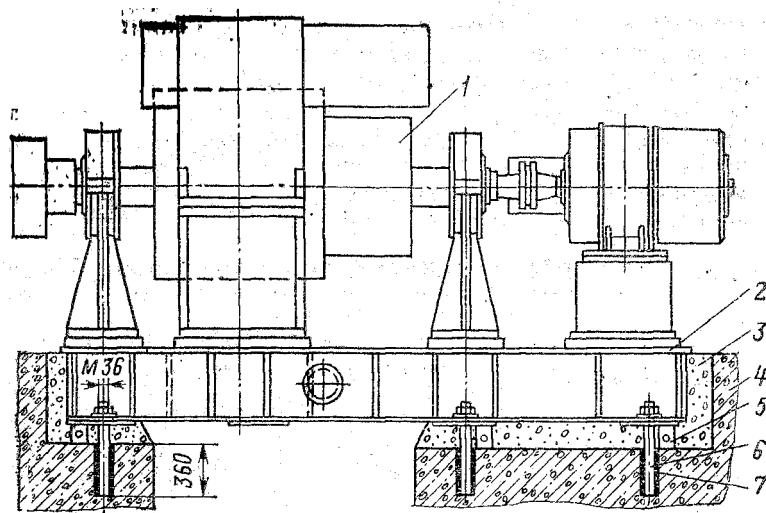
Крепление агрегата на бетонном фундаменте приклеенными анкерными болтами:
